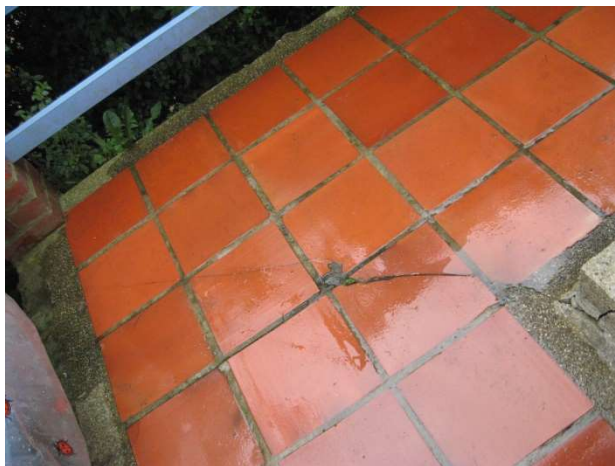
Punzonamiento de placa de piso debida a apoyo de borde de muro (archivo propio)
